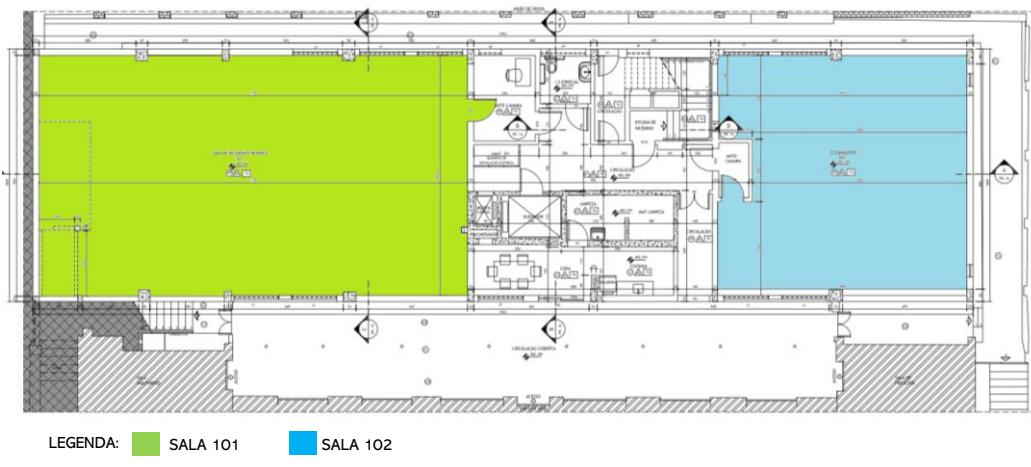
Planta baixa - 1º pavimento: salas 101 e 102.
